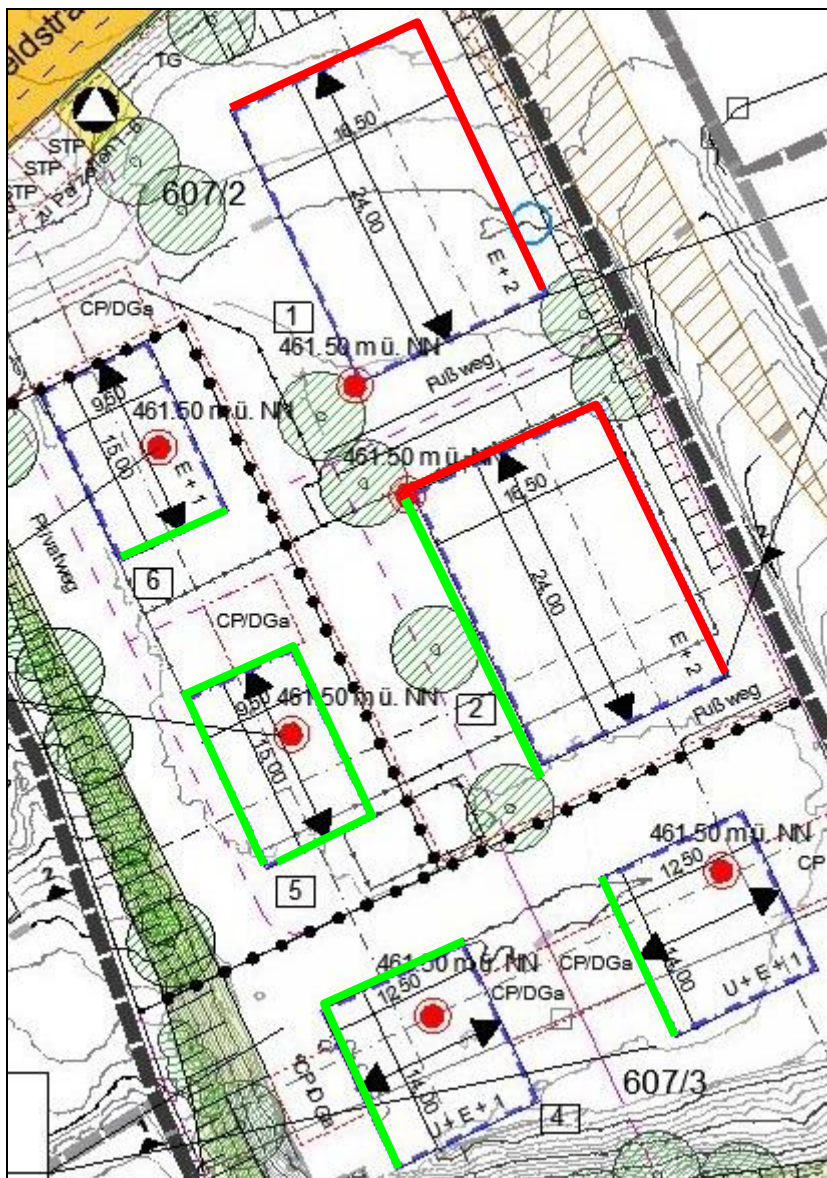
Planskizze; Fassaden mit bzw. ohne Schallschutzmaßnahmen
